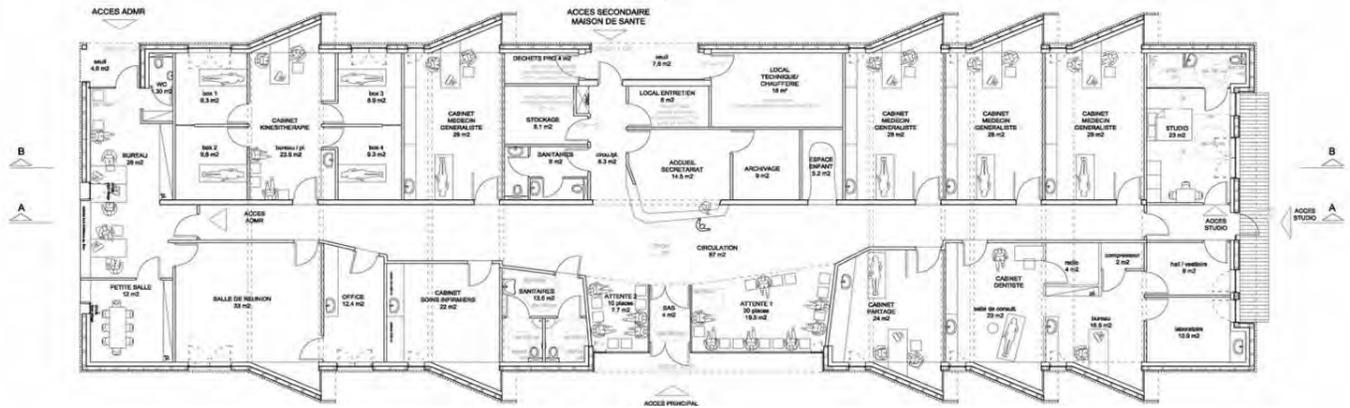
Planta arquitectónica. Fuente: archdaily.mx S/E.
